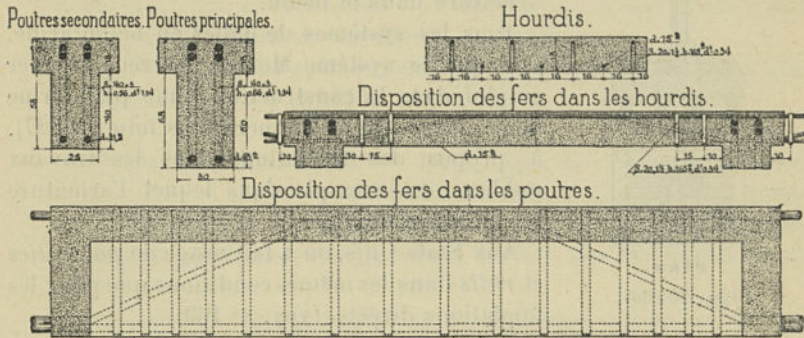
Bâtiment de machines à Seraing, Radier général.
